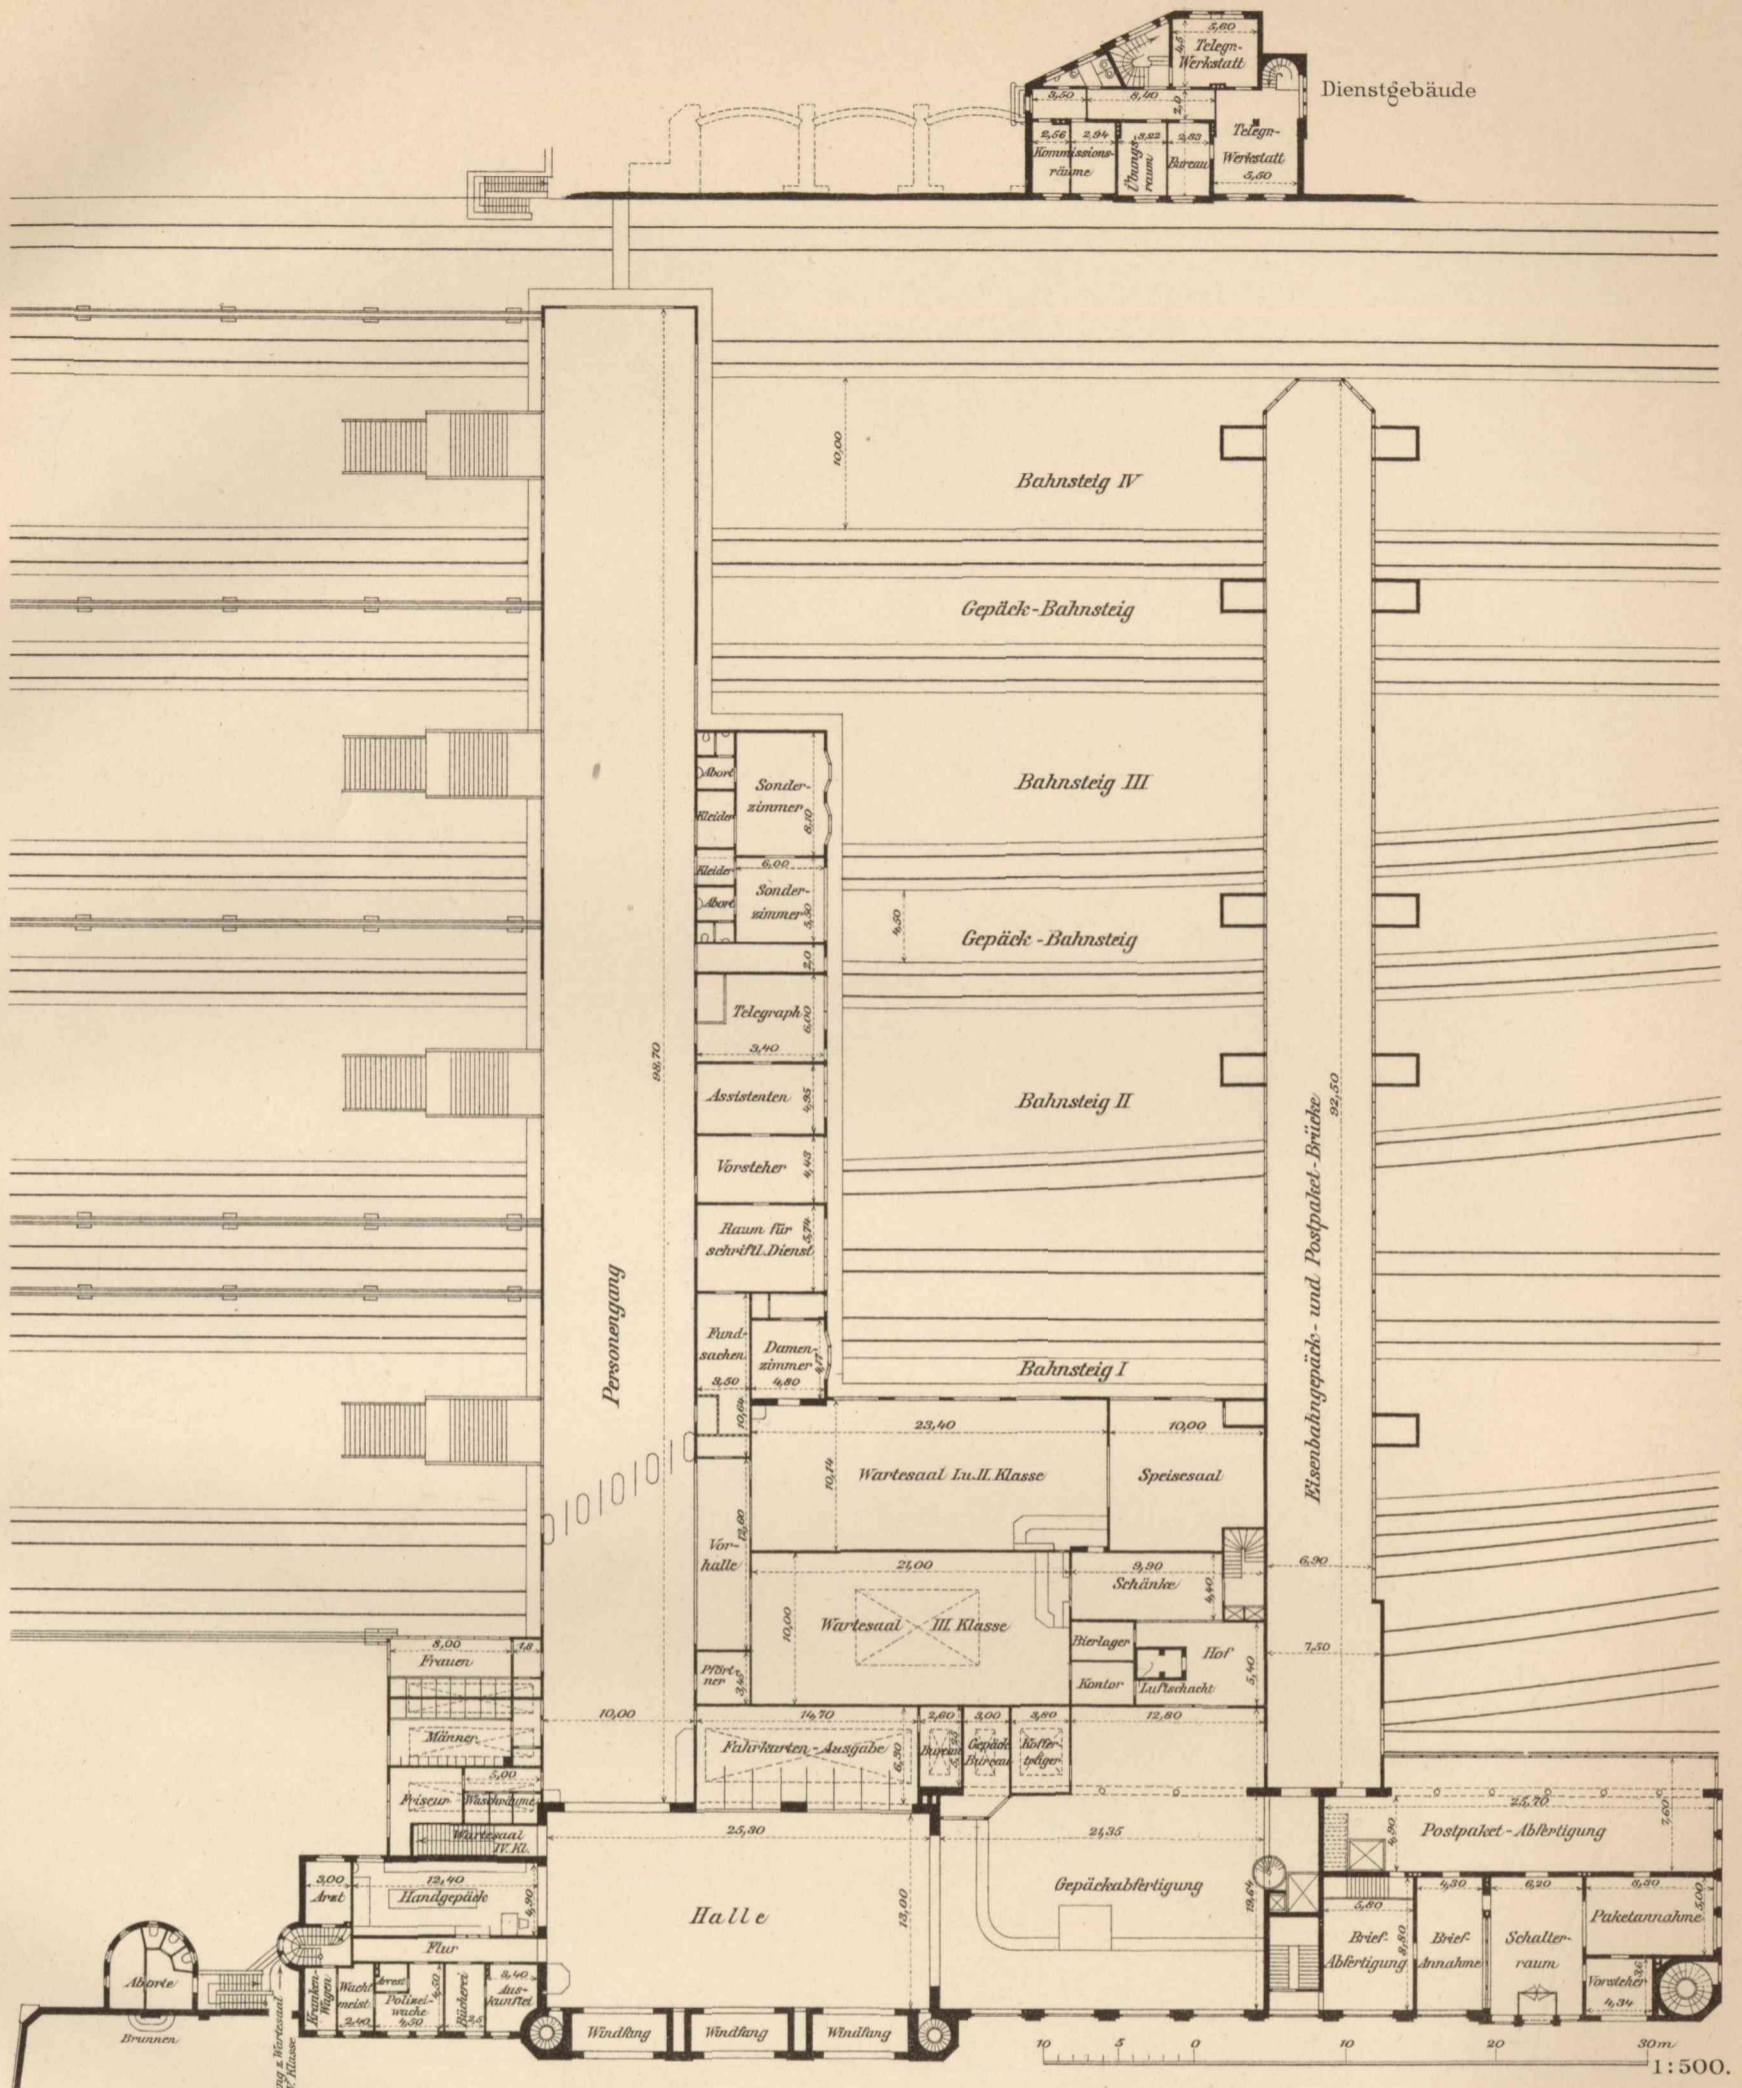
Grundriß des Eisenbahn-Empfangsgebäudes.
